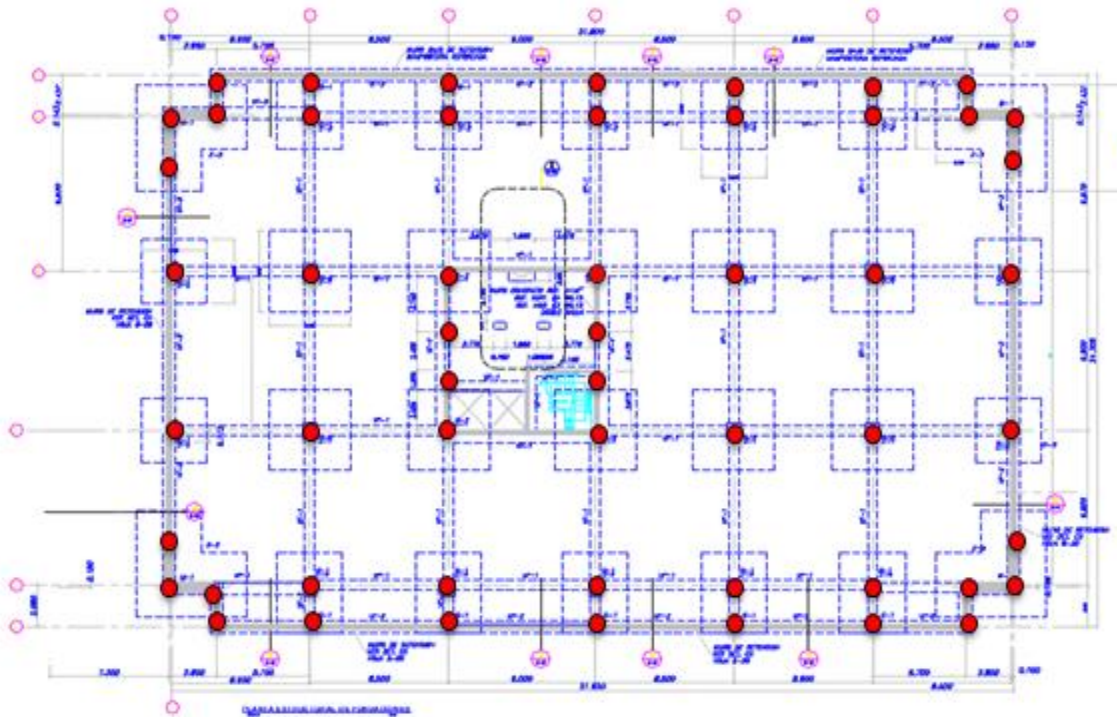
Distribución en planta de los aisladores sísmicos del mismo tipo (HDR,LRB,FPS).
